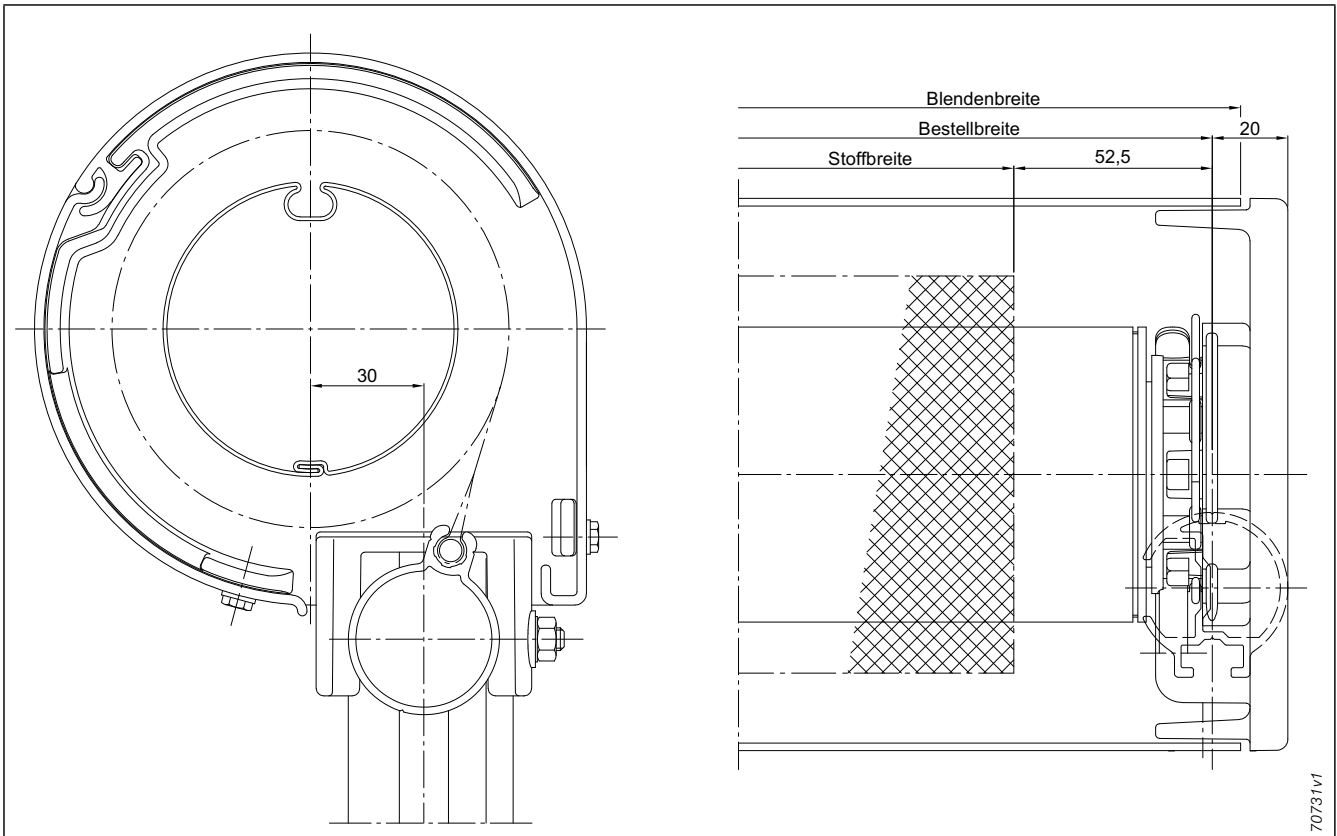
Fassaden-Markise 201 mit Blende Typ 8.3
